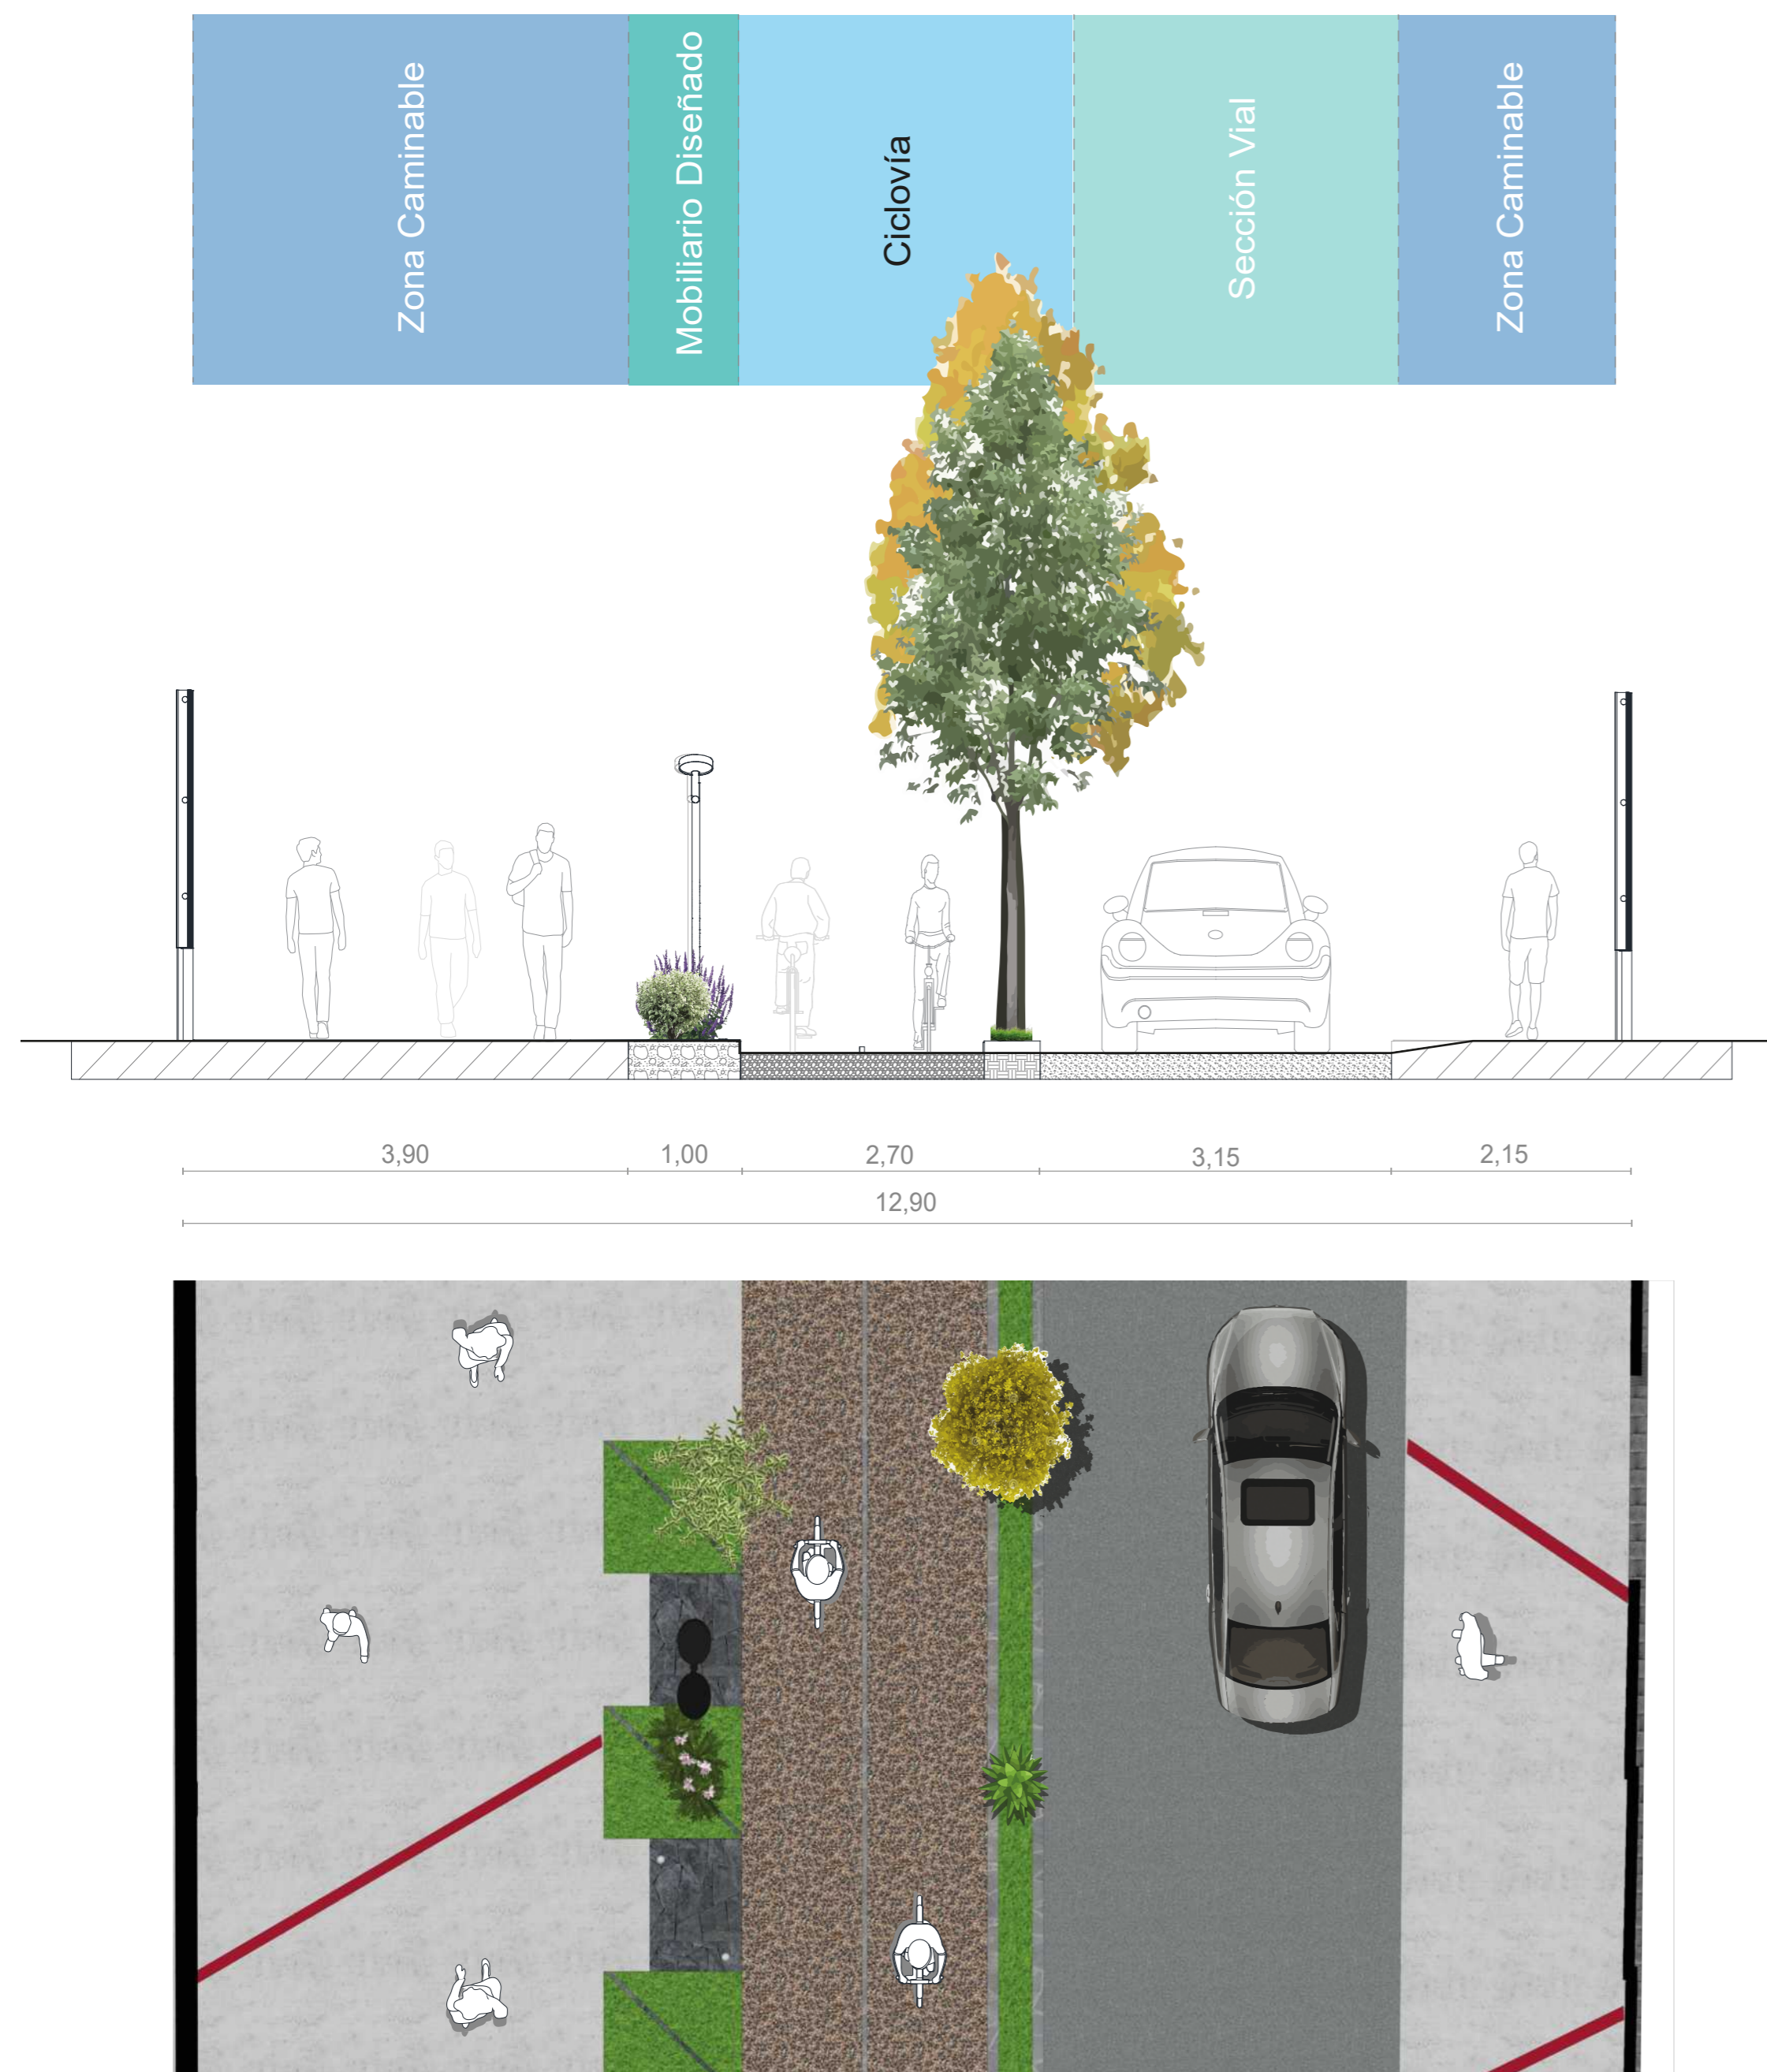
Planta-Sección de la propuesta en el Tramo 7
